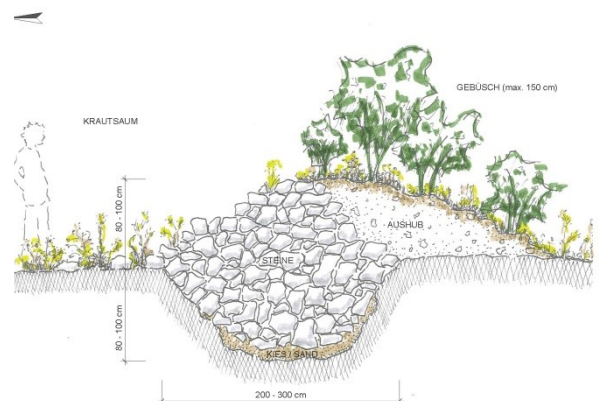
Coupe transversale d'un murgier (source : Barbara Kirsch / Karch)
